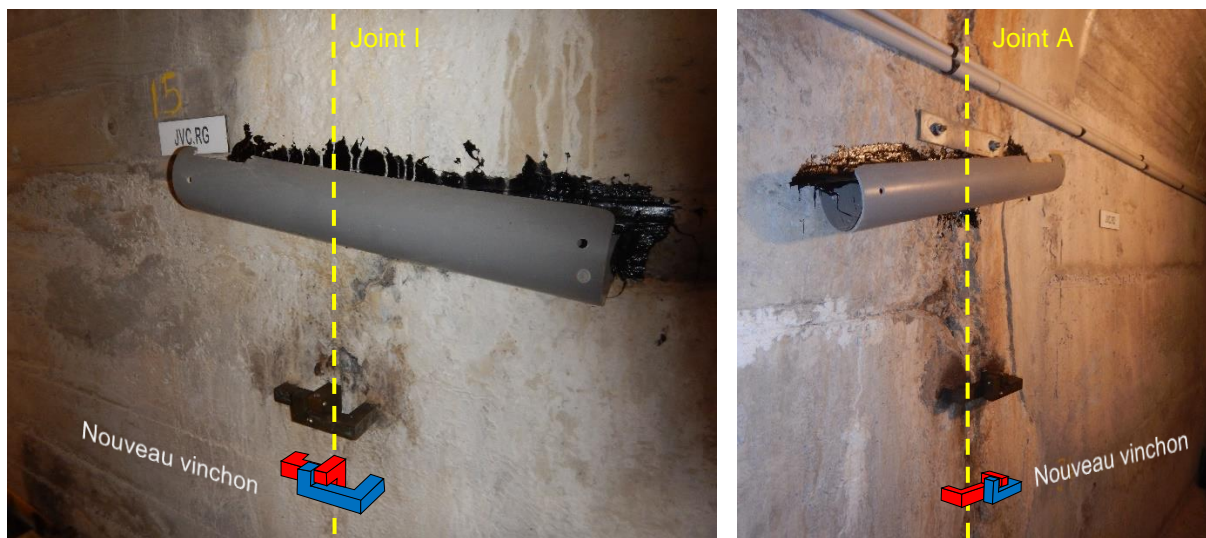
Vinchons existant et position des nouveaux vinchons au droit des joints A et I en galerie du barrage
